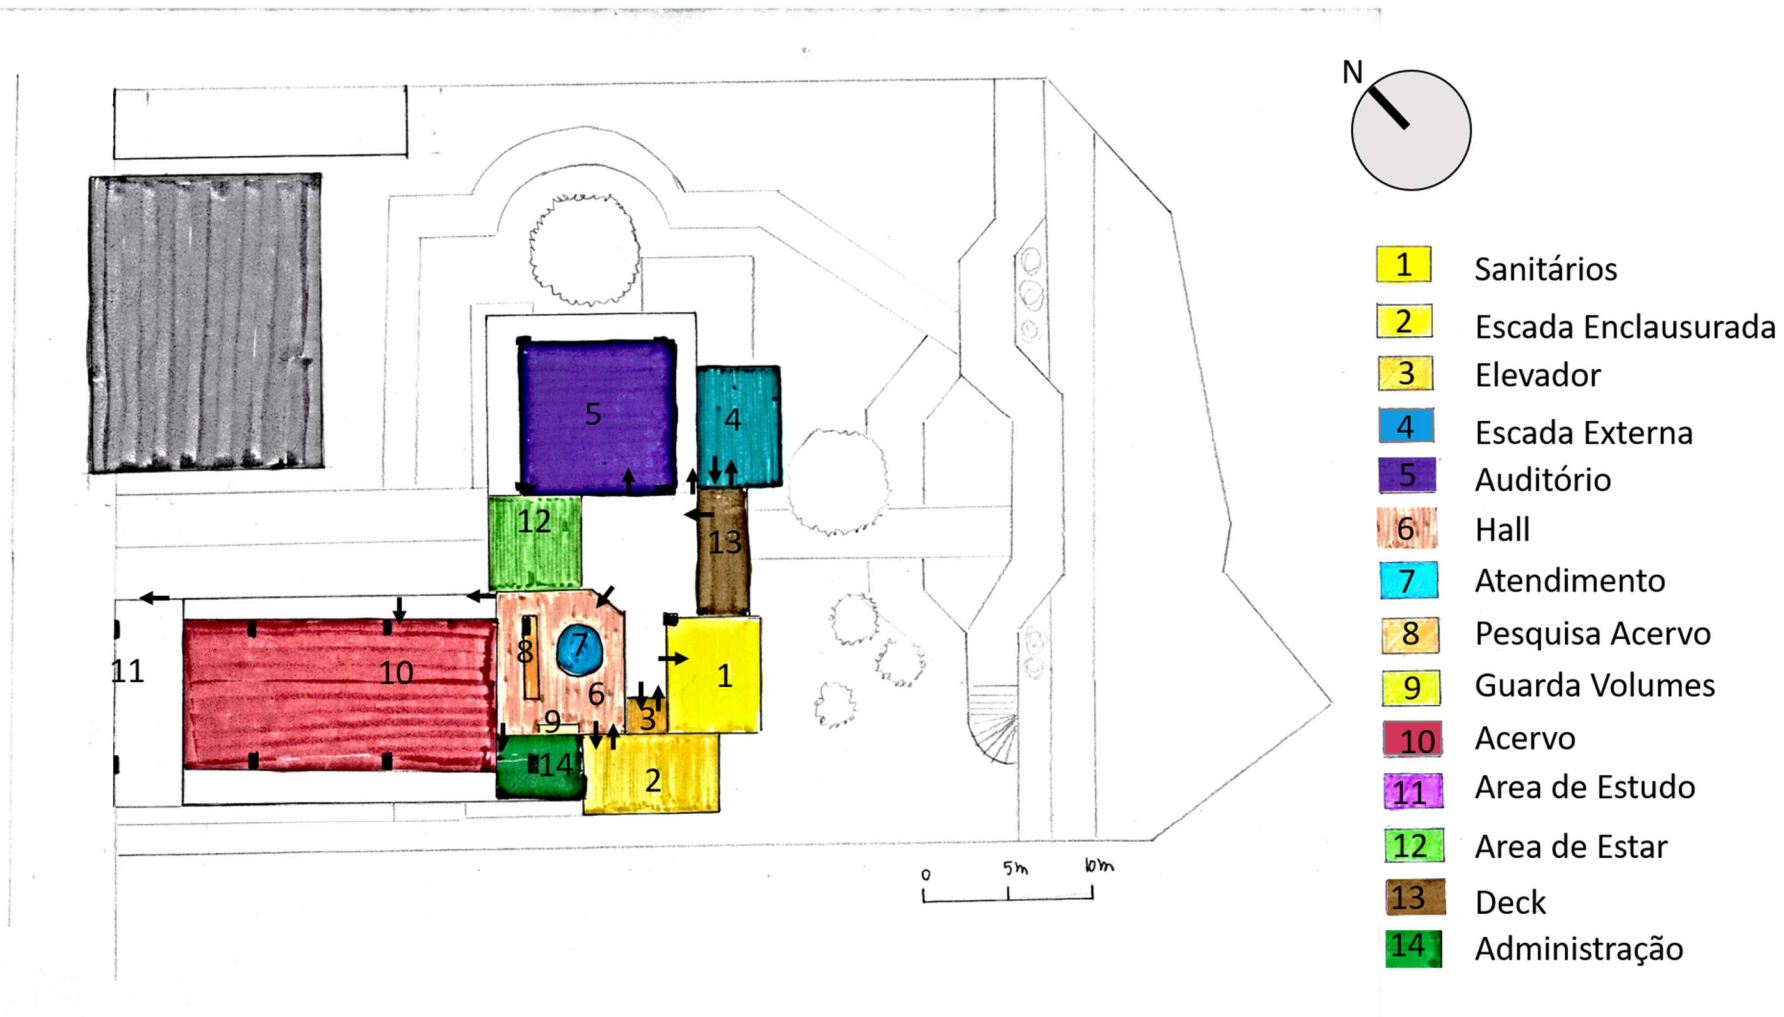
planta baixa quarto pavimento. Fonte: Arquivo pessoal
